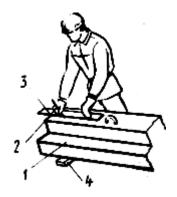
Подготовка ригеля к монтажу:
